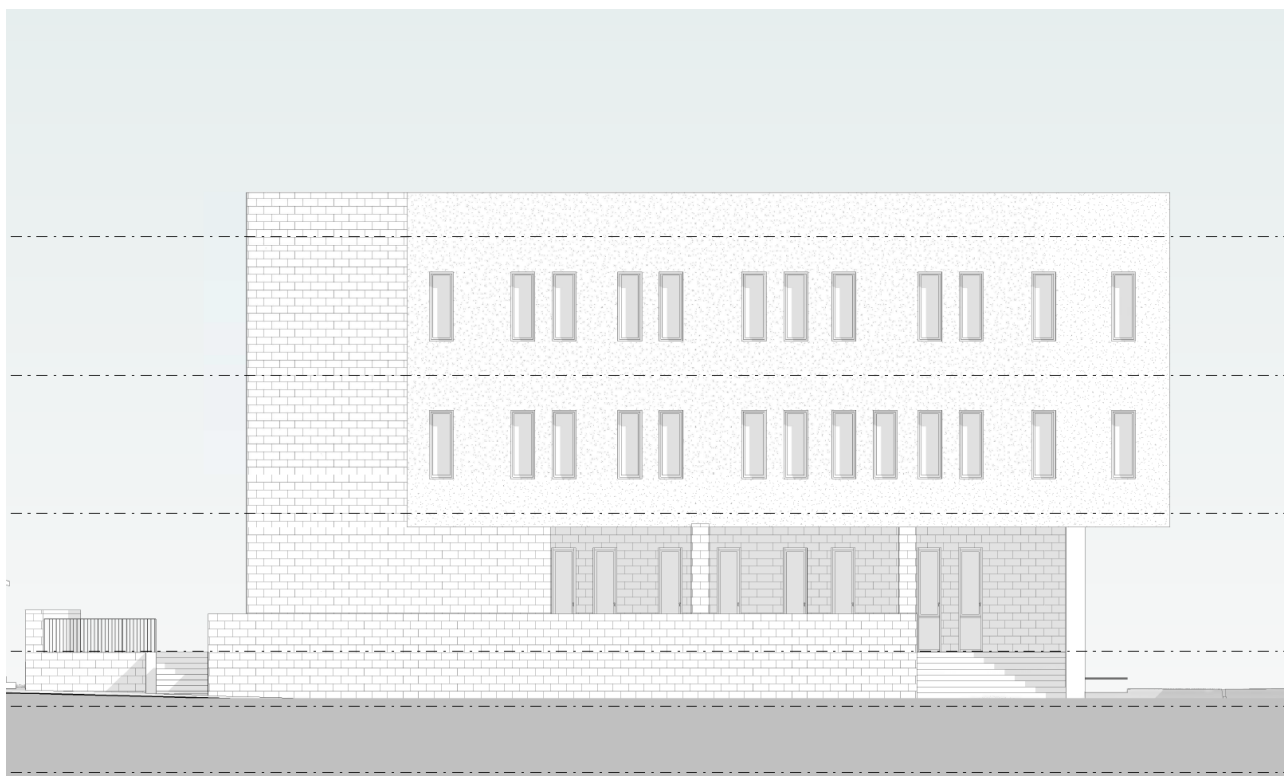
prospetto corte interna, lato via Valfonda (nord-est)
